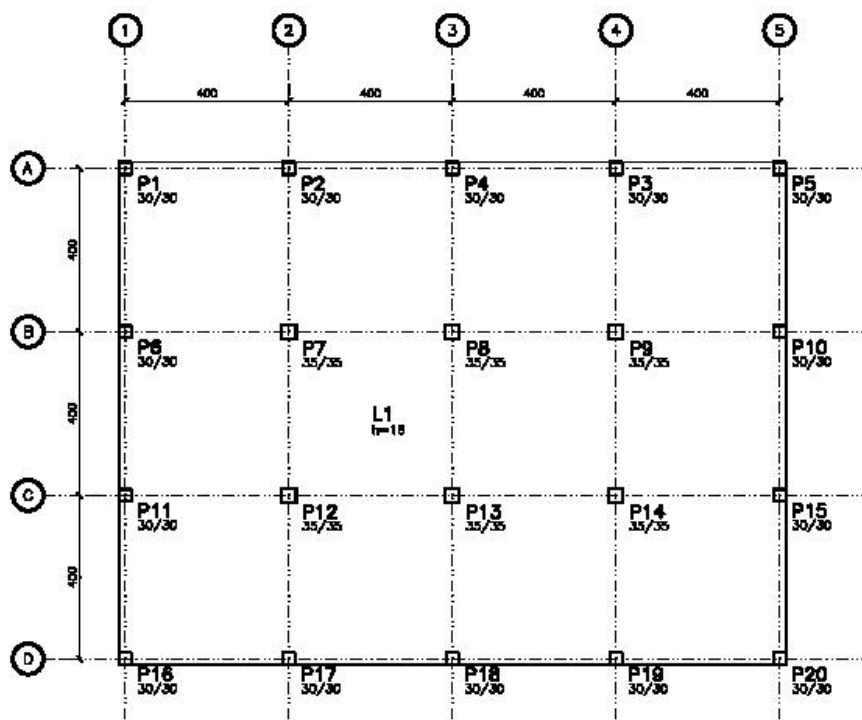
Planta do pavimento em malha quadrada (tipo B)
